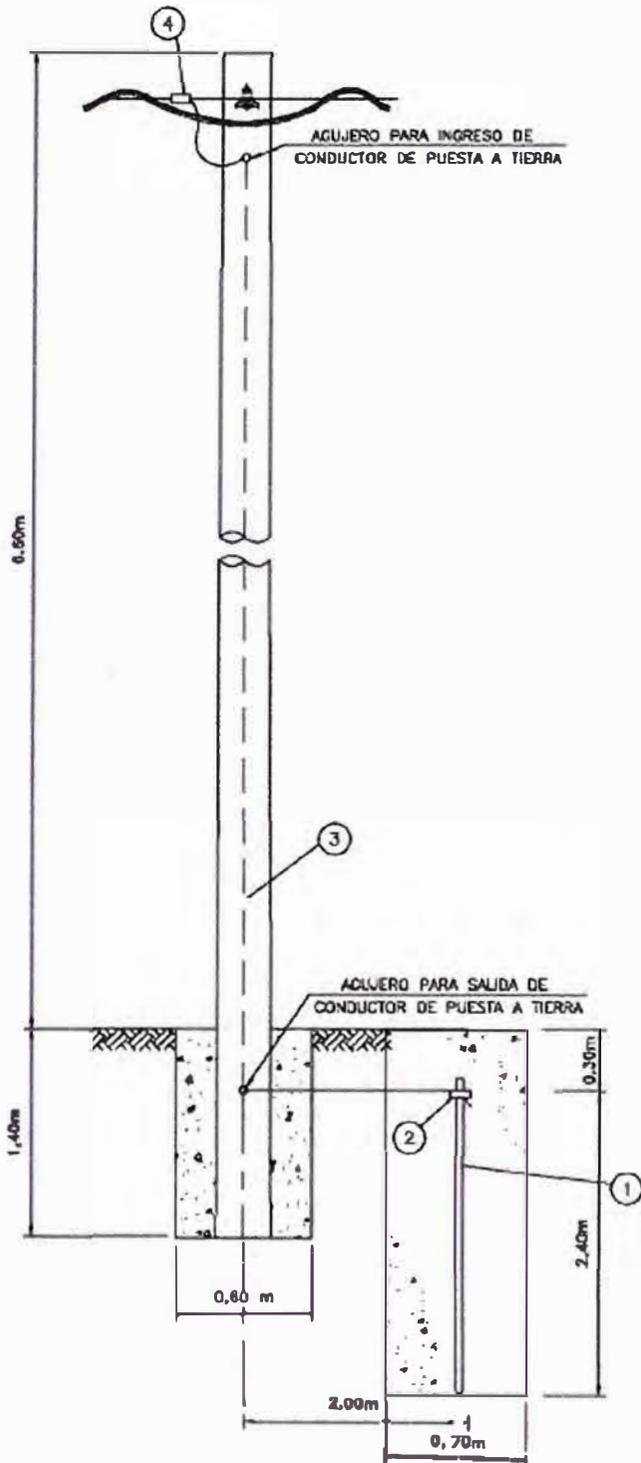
Puesta a tierra para estructuras de concreto armado en redes secundarias /9/.
